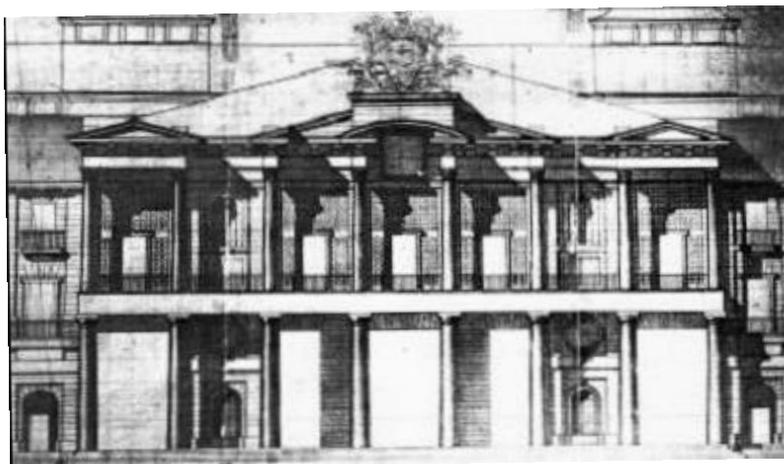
Plano de Fachada del Proyecto original del equipo de Luis Moya.
